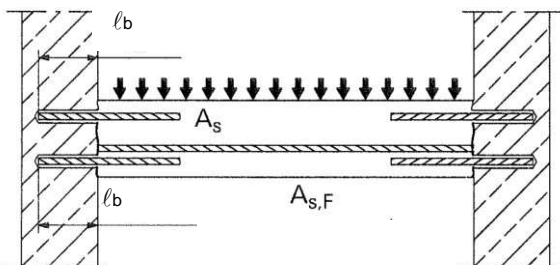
Recouvrement d'armatures pour la liaison de dalles et poutres
